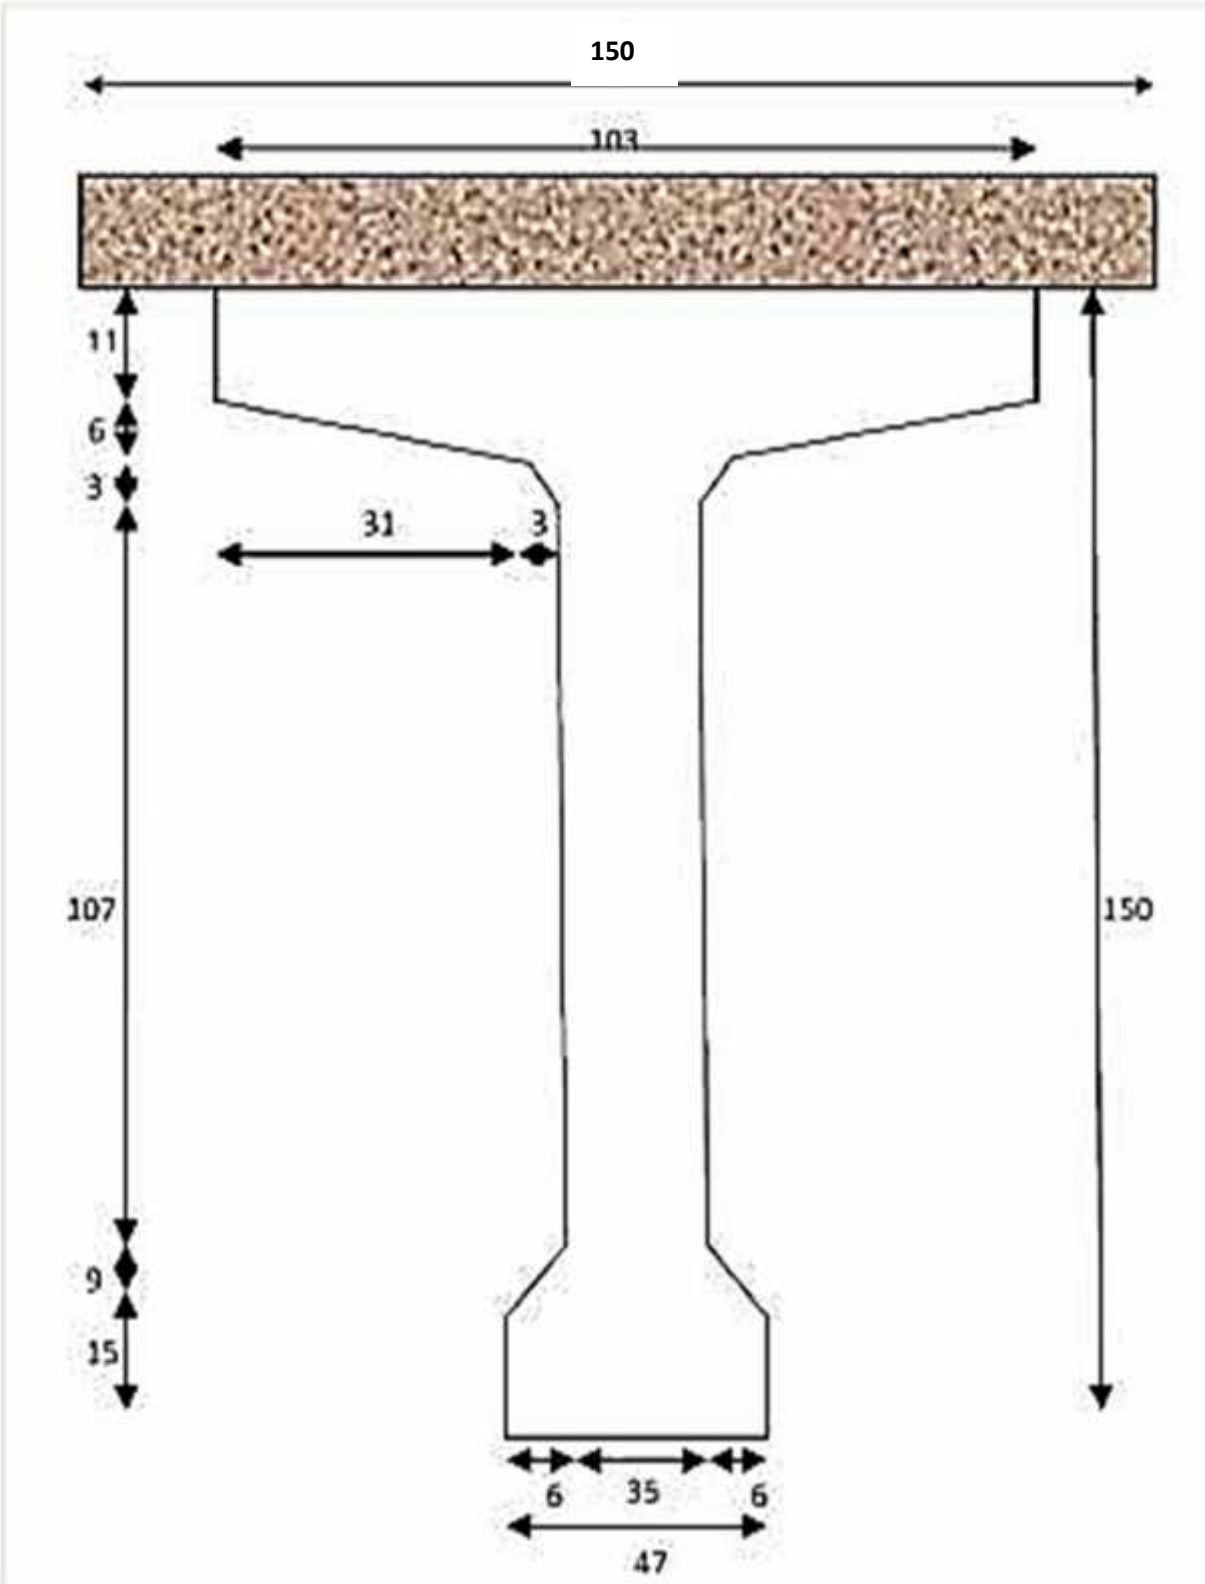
Section intermédiaire de la poutre préfabriquée
